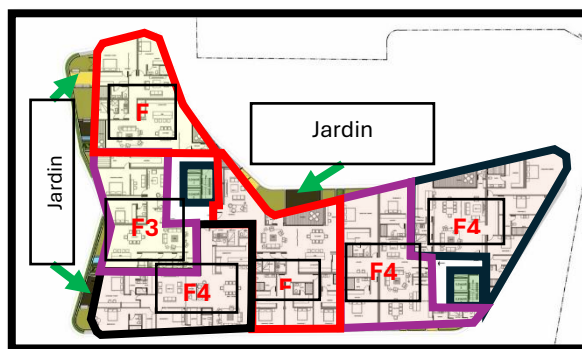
plan R+4 www.archdaily.com traite par les auteurs
